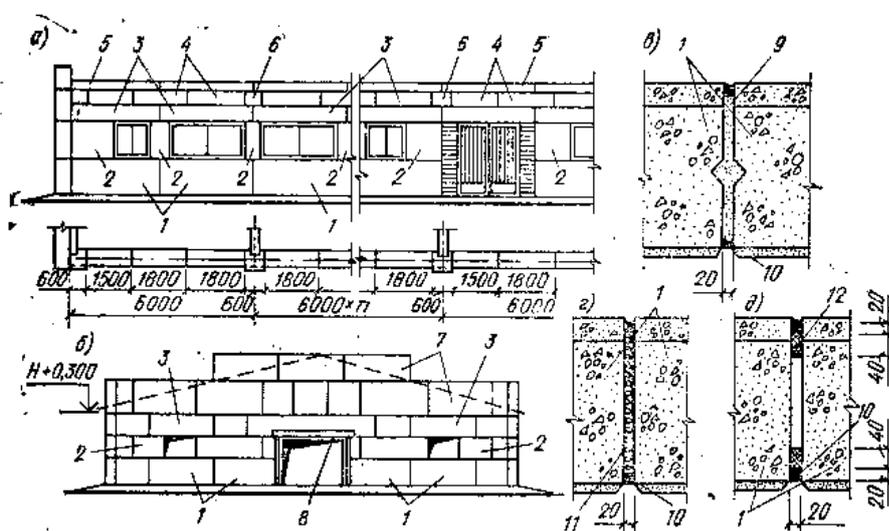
Стены из крупных блоков: а – разрезка продольной стены животноводческого здания на блоки; б – то же, торцевой; в – вертикальный стык рядовых блоков; г, д – температурный шов; 1 – рядовой блок; 2 – простеночный; 3 – перемычный; 4 – подкарнизный; 5 – карнизный; 6 – доборный блок; 7 – парапетный блок; 8 – железобетонная рама ворот; 9 – цементный раствор М100; 10 – мастика; 11 – просмоленная пакля; 12 – упругая прокладка
